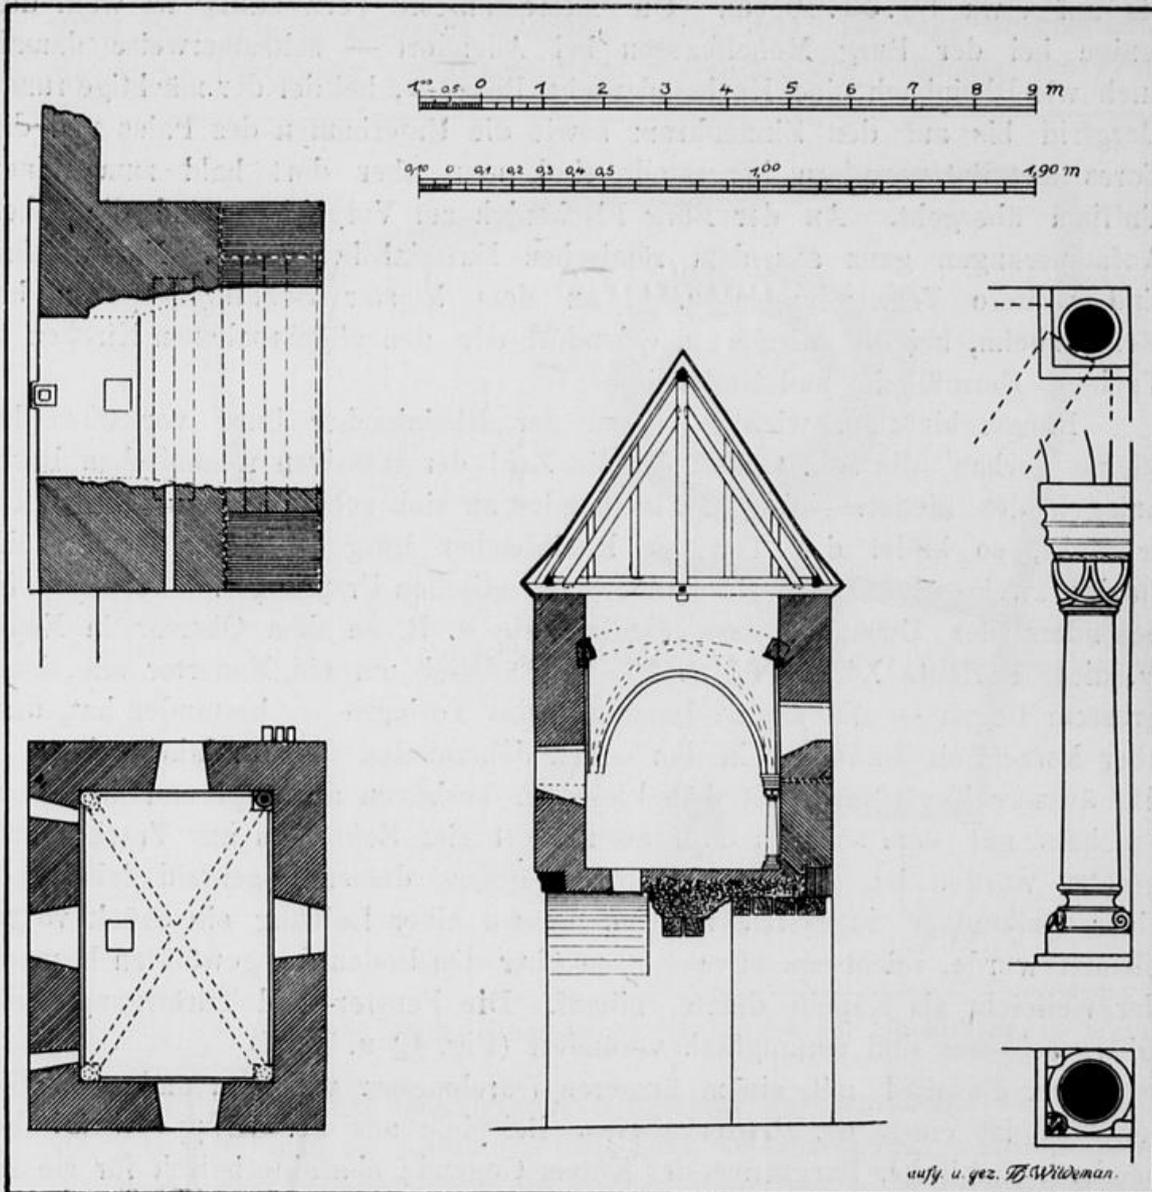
Burg Rheinbach. Grundriss, Schnitt und Detail des Torbaues.
